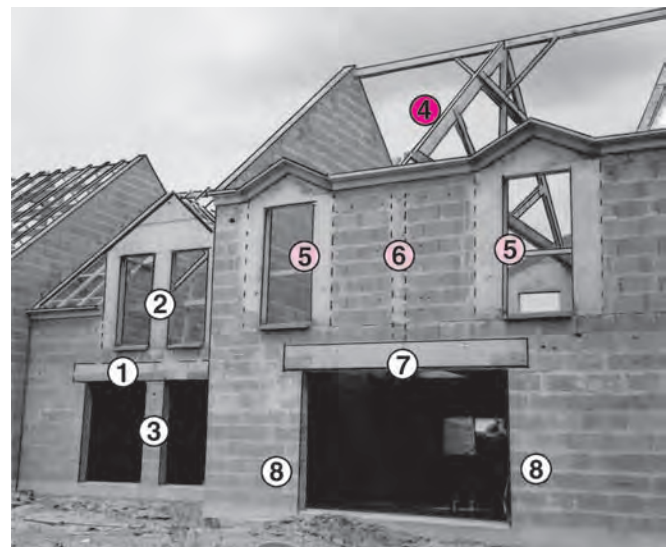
Façade en maçonnerie et ouvrages associés en béton armé
